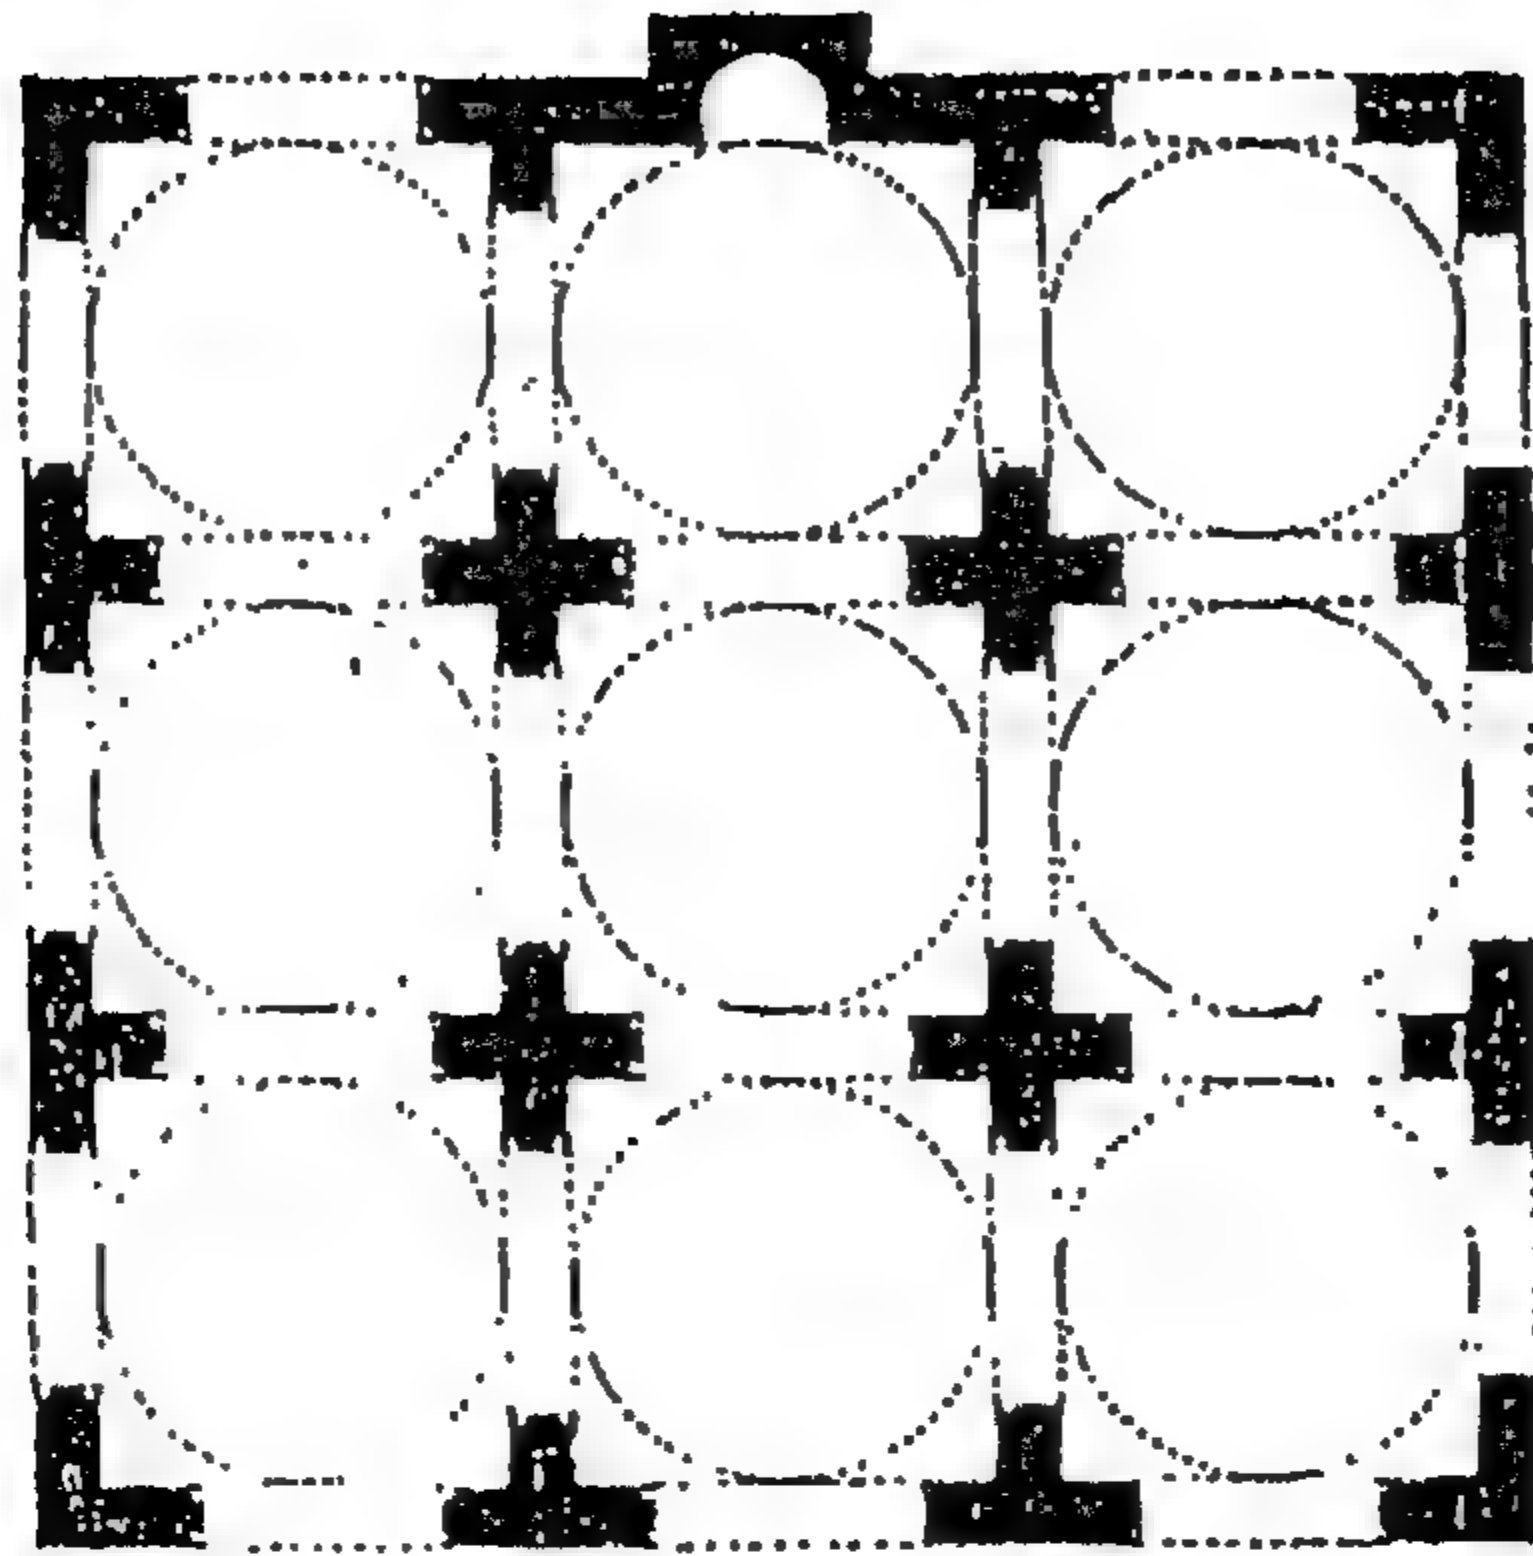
مسقط أفقي لجامع السنانية ببولاق بالقاهرة (عن : Brandenburg) .
